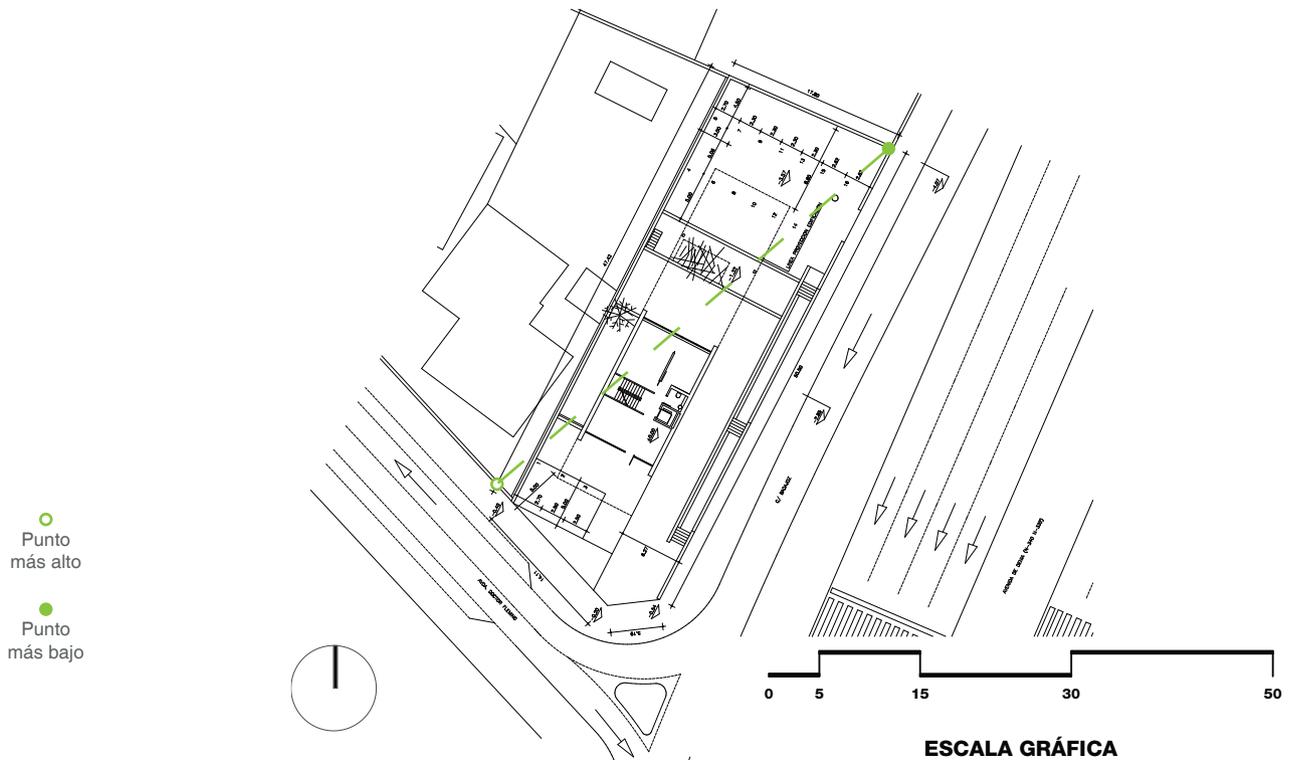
Plano de emplazamiento y topografía del proyecto. Estudio de Javier García-Solera. Escala: 1:750
